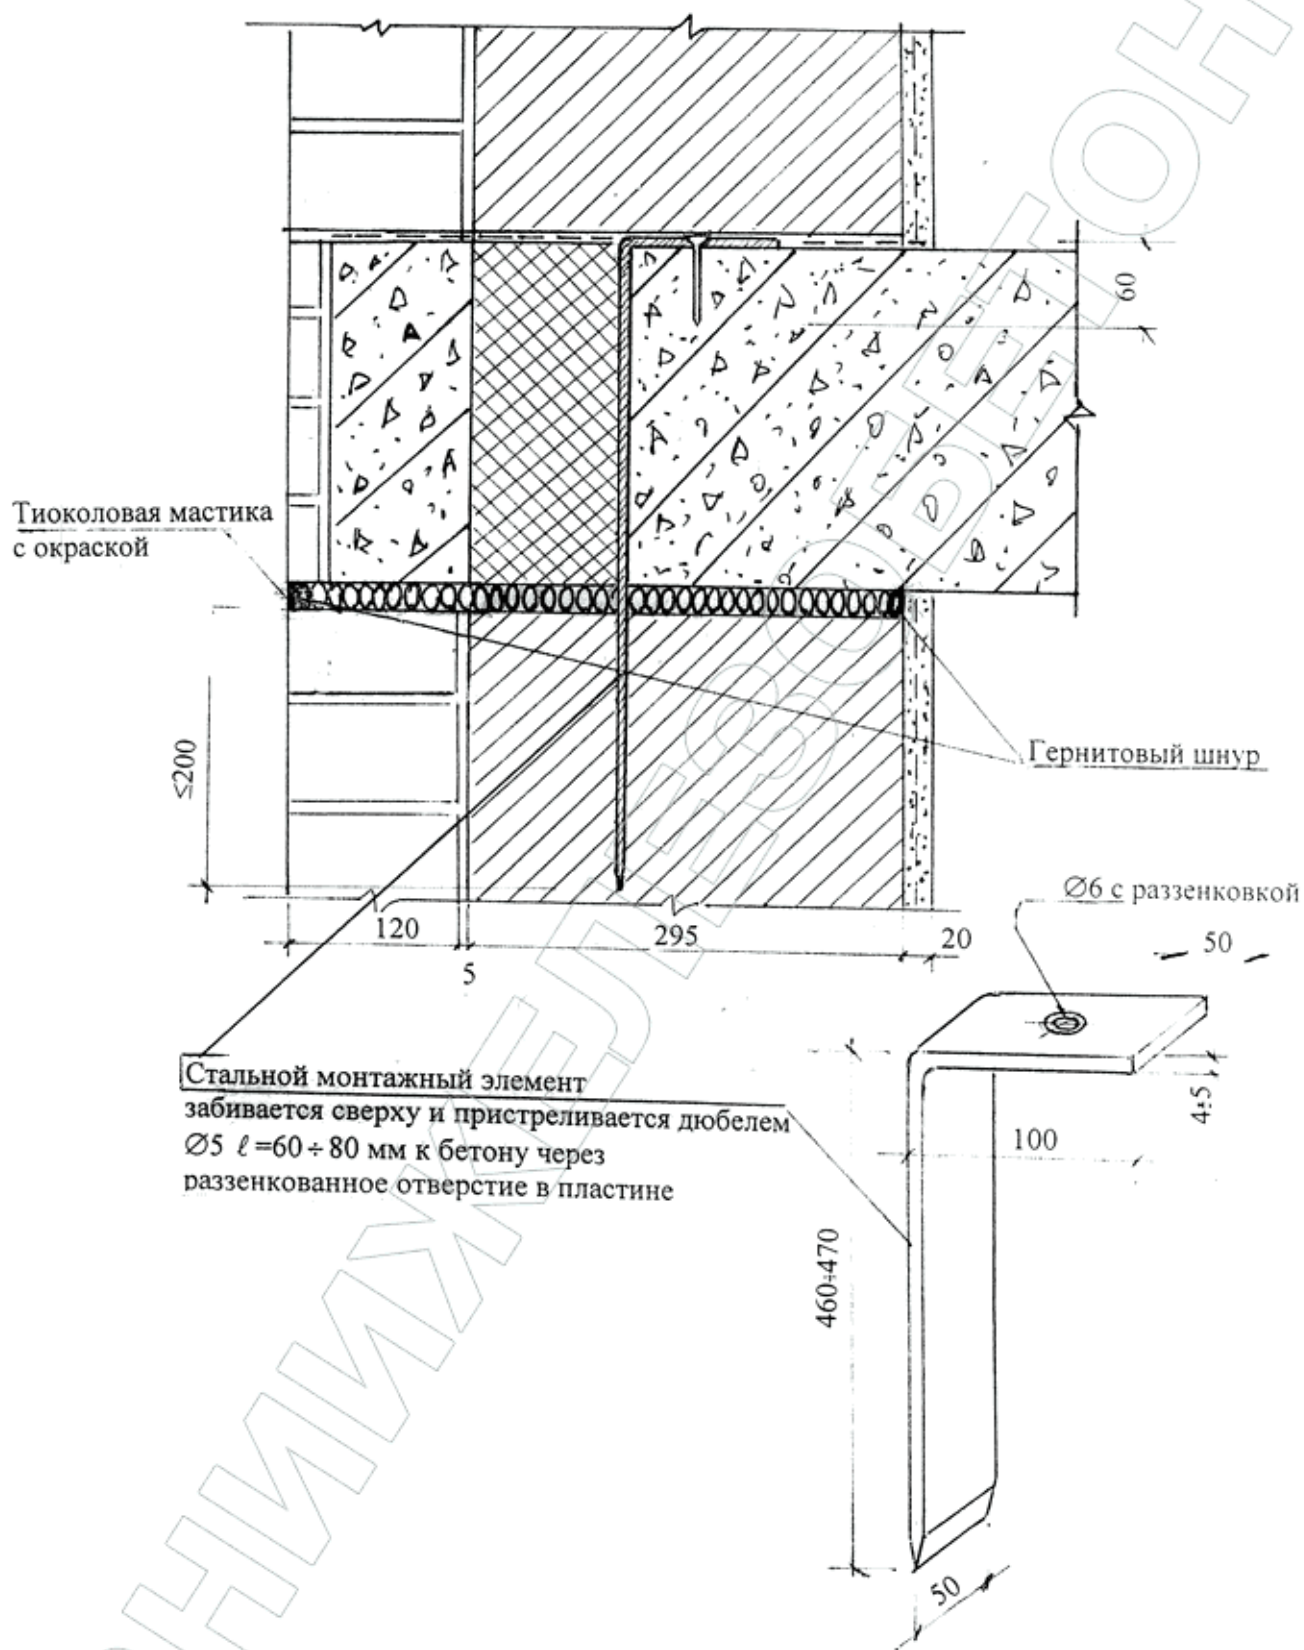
Крепление кладки из полистиролбетонных блоков к железобетонному перекрытию в эркере (вертикальный разрез по простенку)
